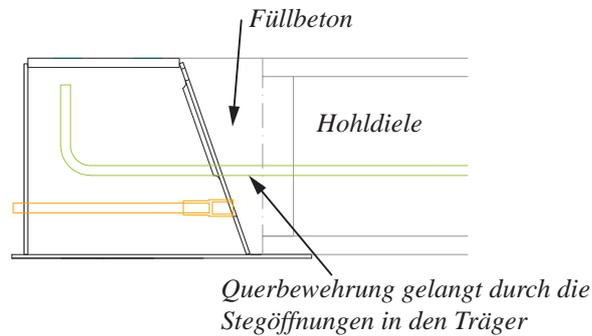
Detailansicht der Träger-Hohlblechen-Verbindung
